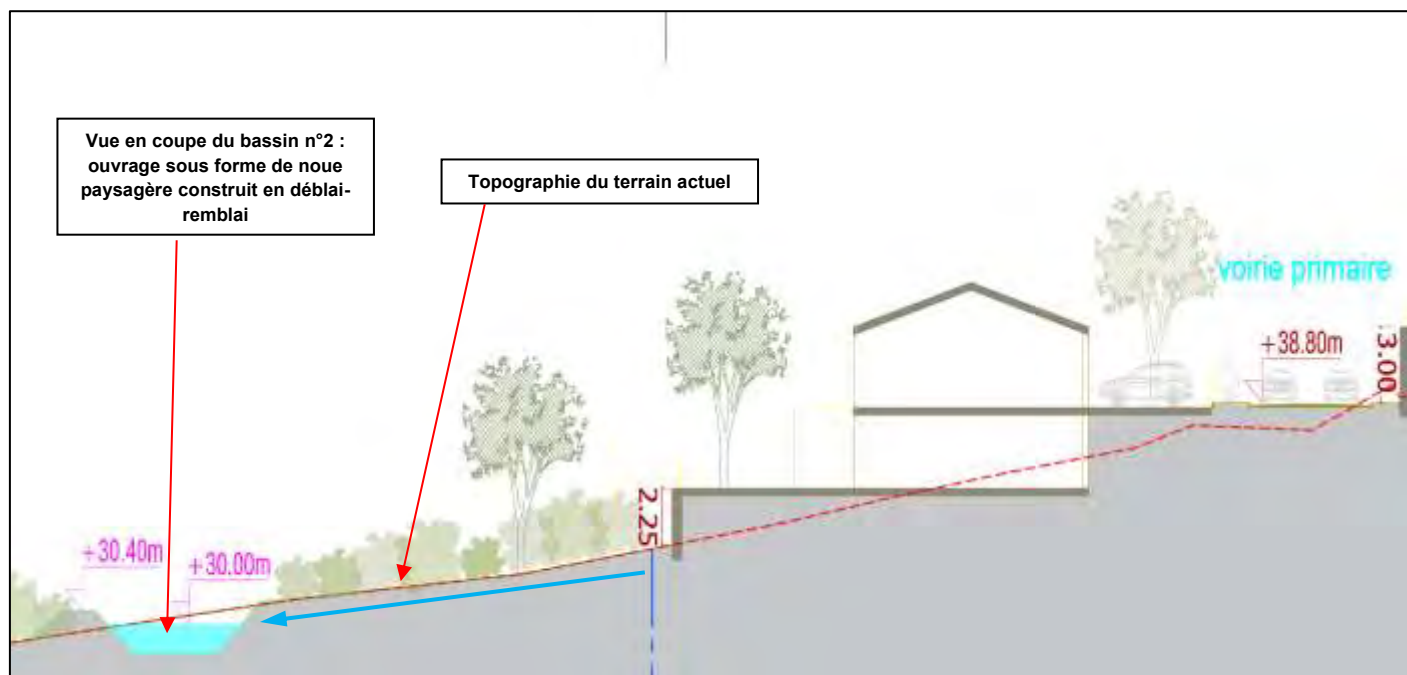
Plan en coupe de principe du bassin n°2 (vue de la façade sud du hangar)
